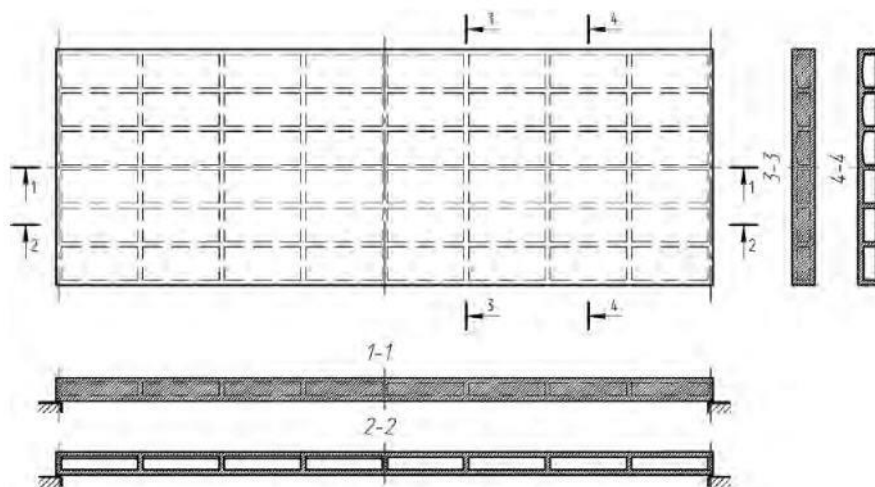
Монолітна залізобетонна плита прогонова будова зі складною внутрішньою геометрією [26]
